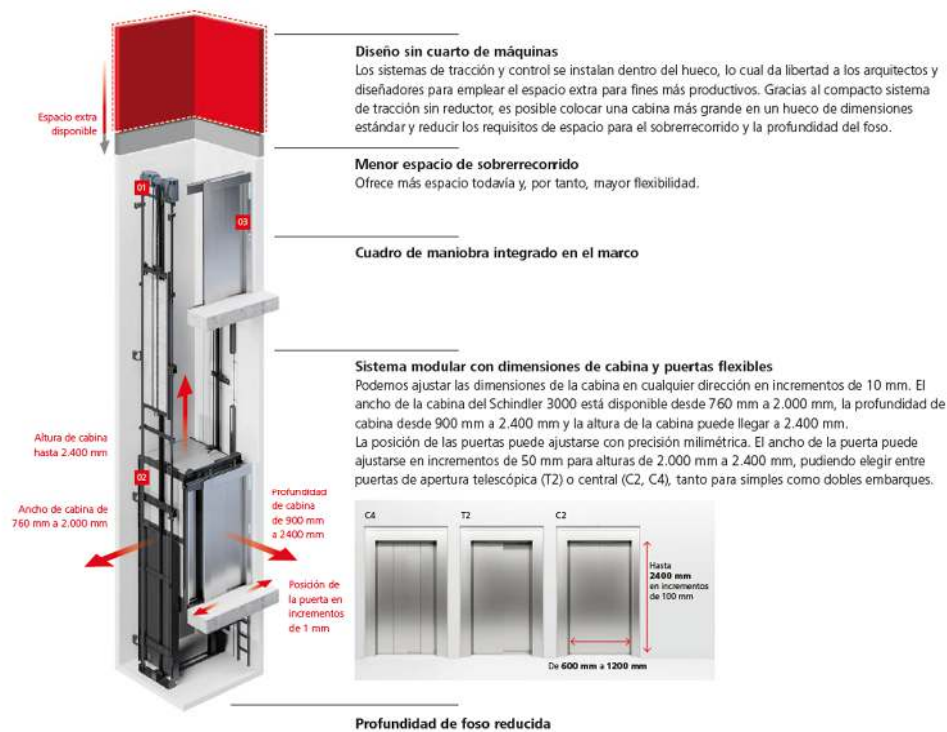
Especificaciones técnicas del Ascensor Schindler 3000. Fuente: <https://www.schindler.pe/es/sobre-nosotros.html>
